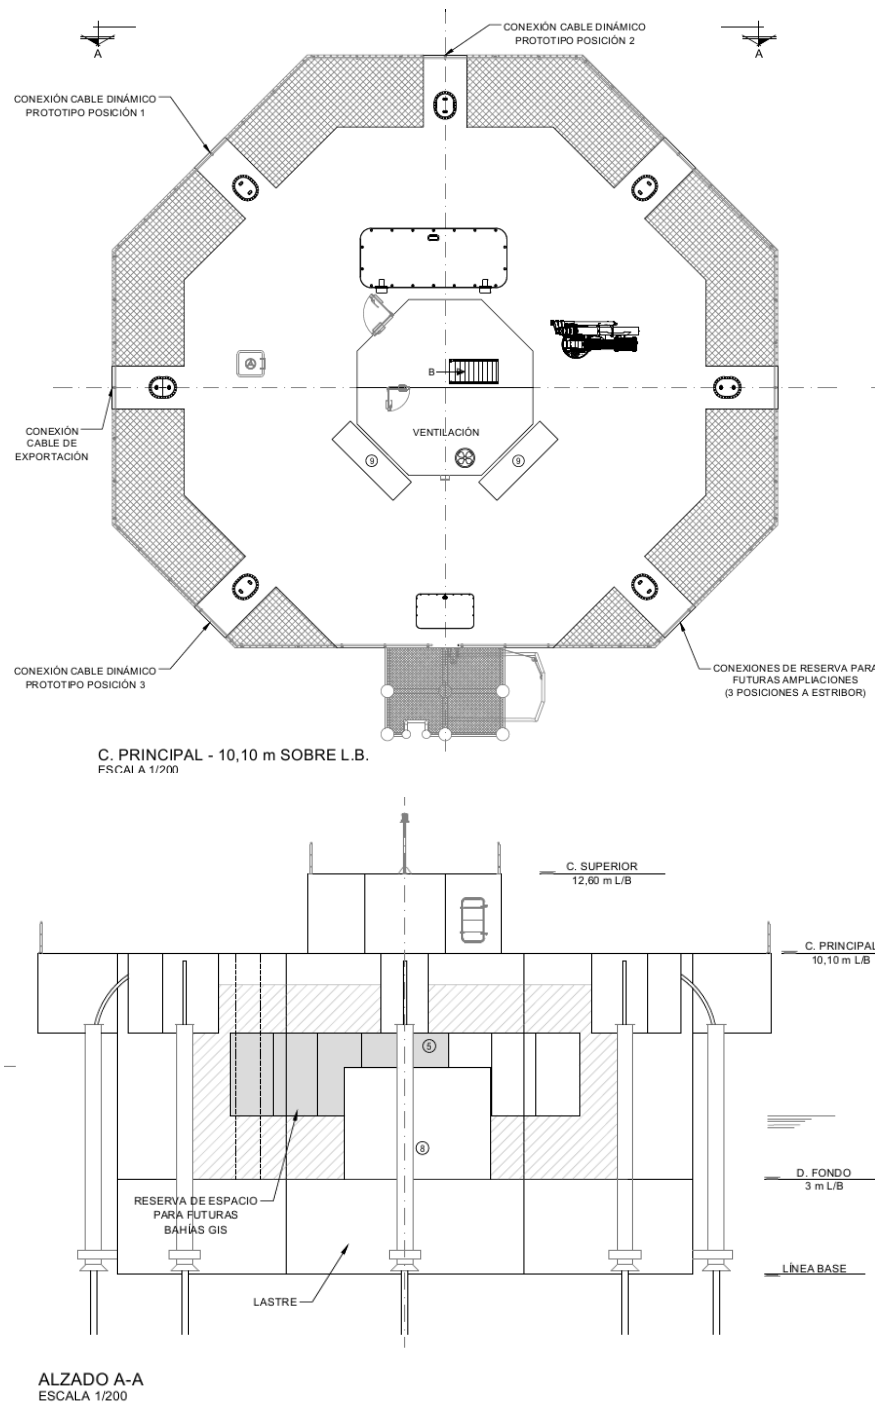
Esquema en planta y alzado de la boya de interconexión.
